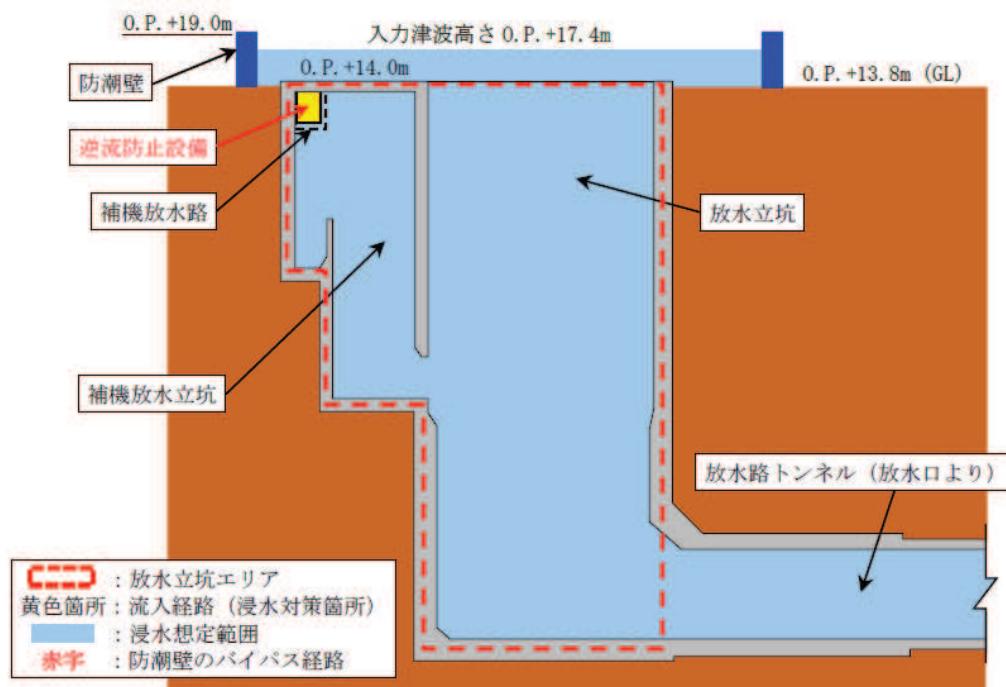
第 2 号機 放水立坑 浸水対策配置図（A-A 断面図）
